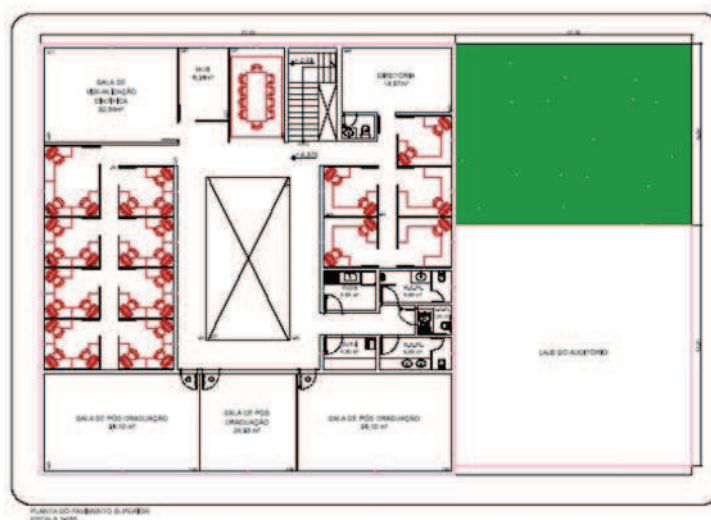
(a) – Planta do Nó LCFT/ITA da Rede CCV: 1º piso com o auditório.
